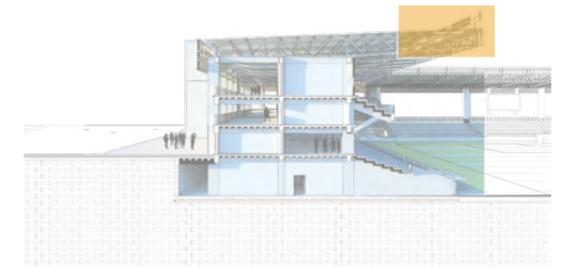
Detalle de cubierta en voladizo. Fuente: Elaboración propia.
